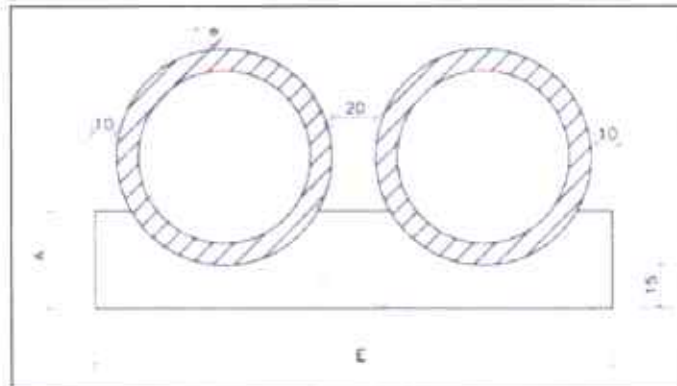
Bueiro Simples Tubular de Concreto (BSTC).
